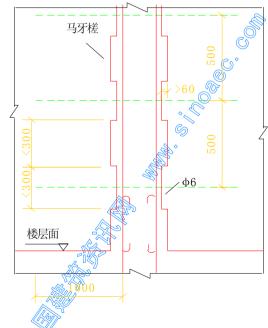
0. 3-1 拉结钢筋布置及马牙槎示意图
